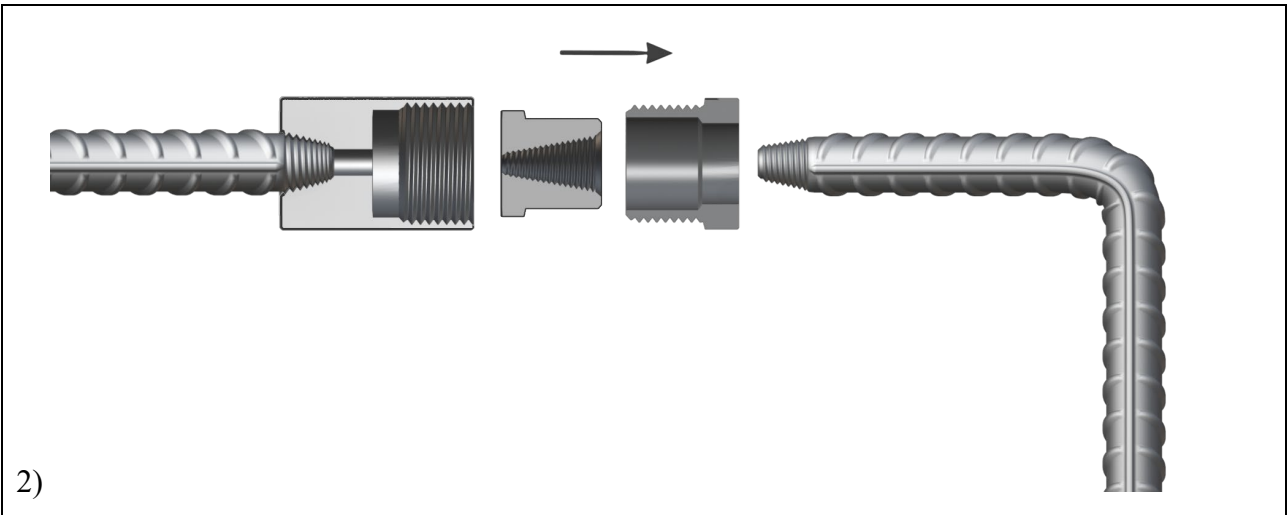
Сборка позиционного соединения тип 1 с конической резьбой
